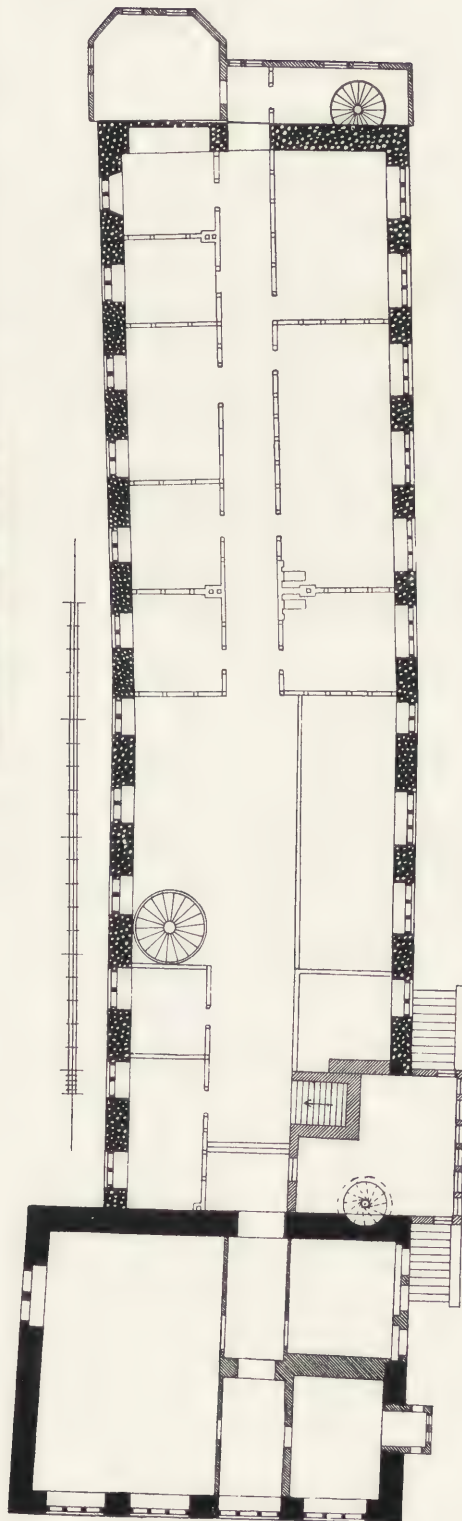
Rathaus zu Halberstadt. Grundriß des Obergeschosses. Nach Aufnahme des Stadtbauamts.
